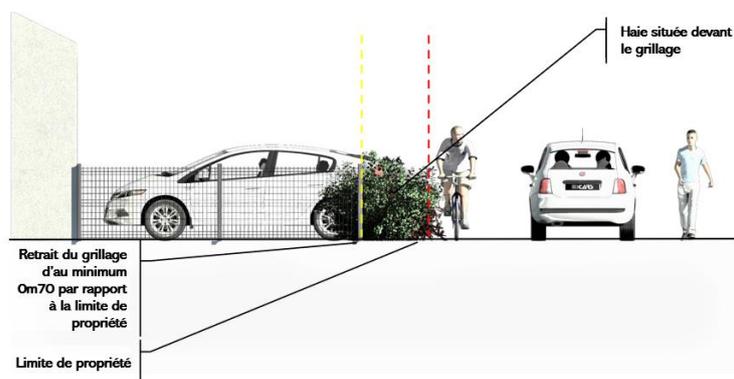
Principe d'implantation du grillage et de la haie de type 1 en vue de profil
